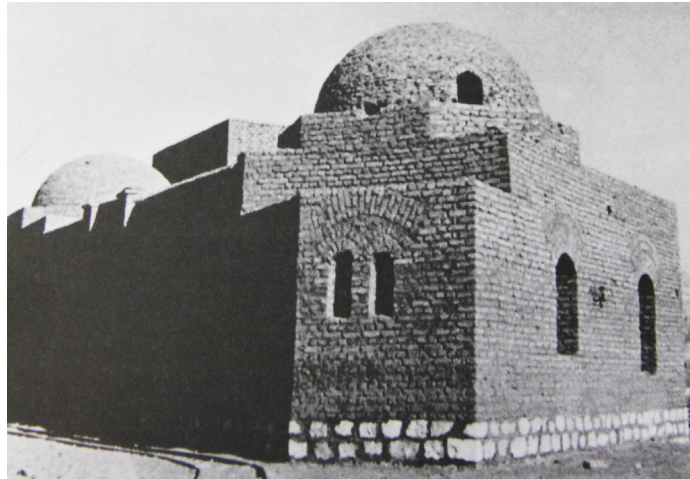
Uma das primeiras casas a serem construídas. Casa de tijolo de terra com fundações de pedra, ainda sem reboco.
